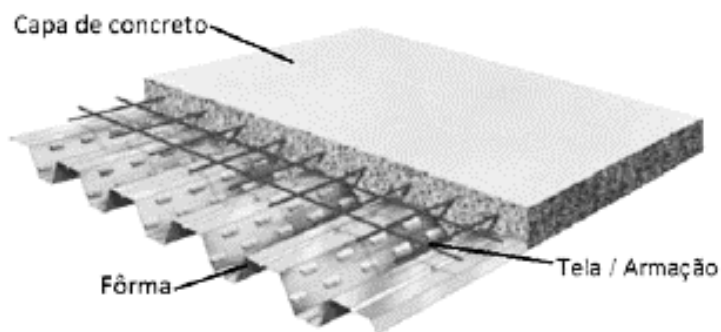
Esquema de laje *steel deck* (FILIZZOLA, 2017)
